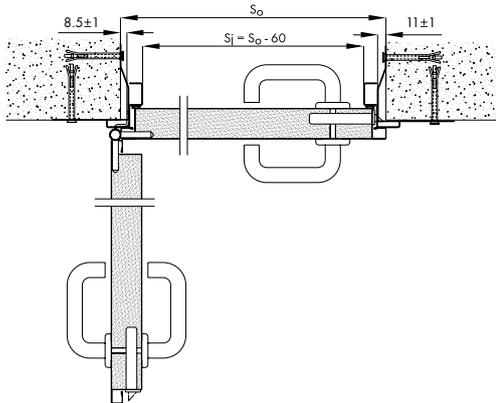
Montage einflügeliger Türen mit Eckzarge - Horizontalschnitt.
